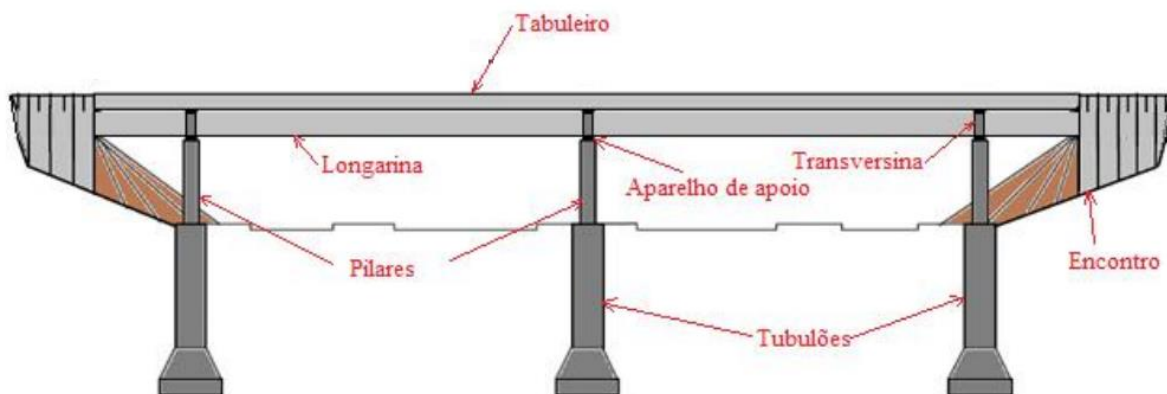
Elementos constituintes de uma ponte. Fonte: Adaptado de Pfeil (1979).
